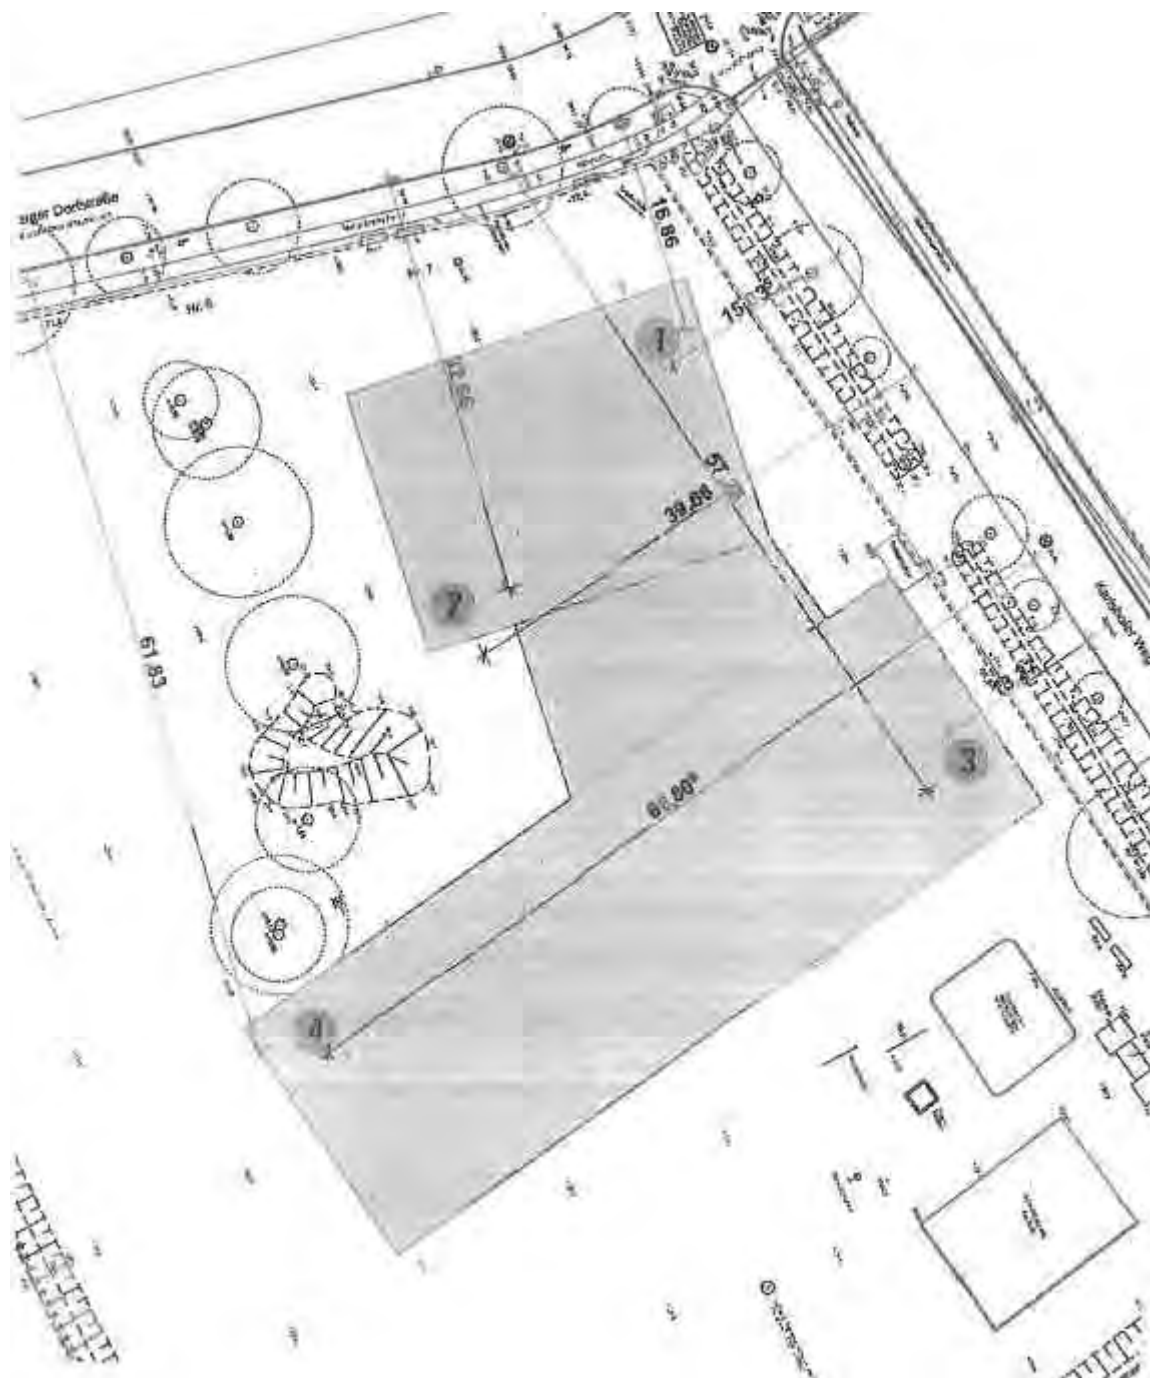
Übersicht zur geplanten Baufläche (grau umrandet) mit Darstellung Untersuchungsgebiet (UG gelb umrandet) und Höhlenbaum (Altweide: weißer Punkt)
